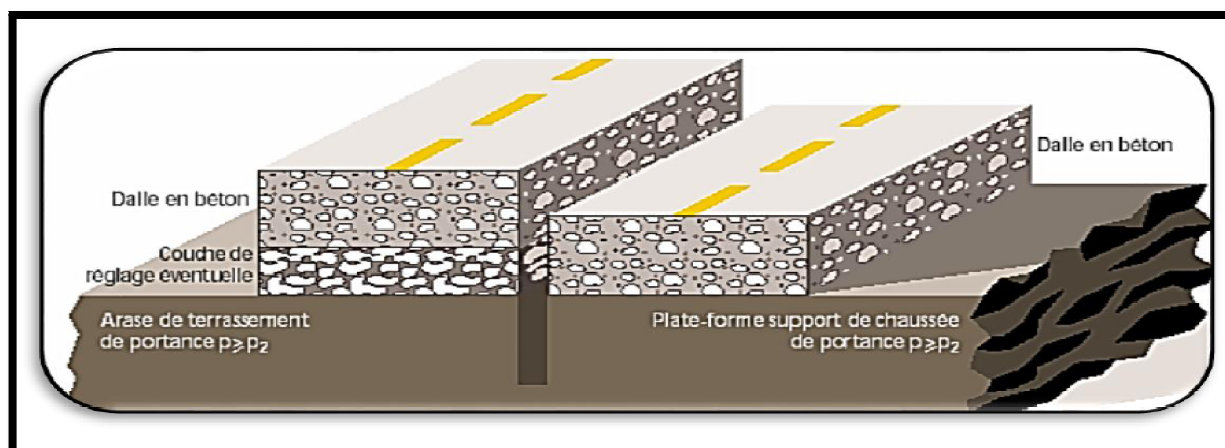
Structure type d'une chaussée rigide. [17]
